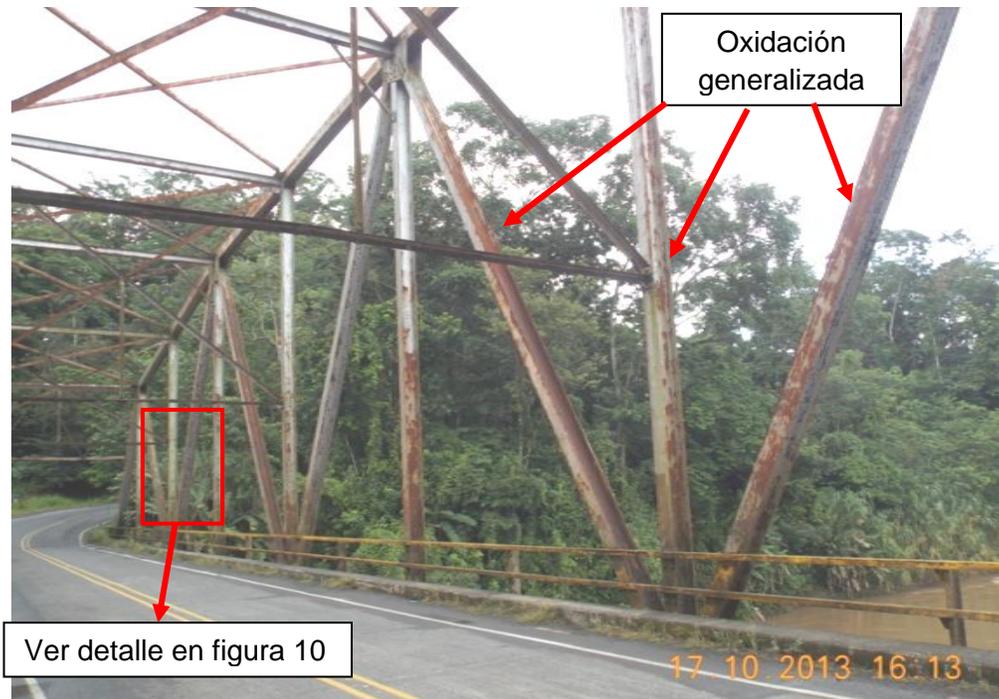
Oxidación en elementos principales y sistema de arriostramiento superior de la armadura (típico)
